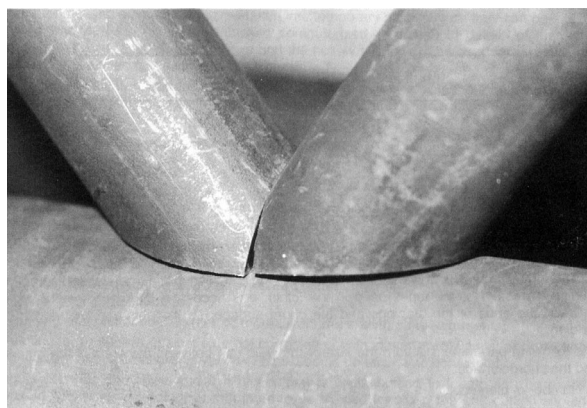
Nó composto por tubos com cortes planos executados por serra, antes da soldagem (uma chapa deve ser inserida entre as extremidades das diagonais para uma solda conveniente)
